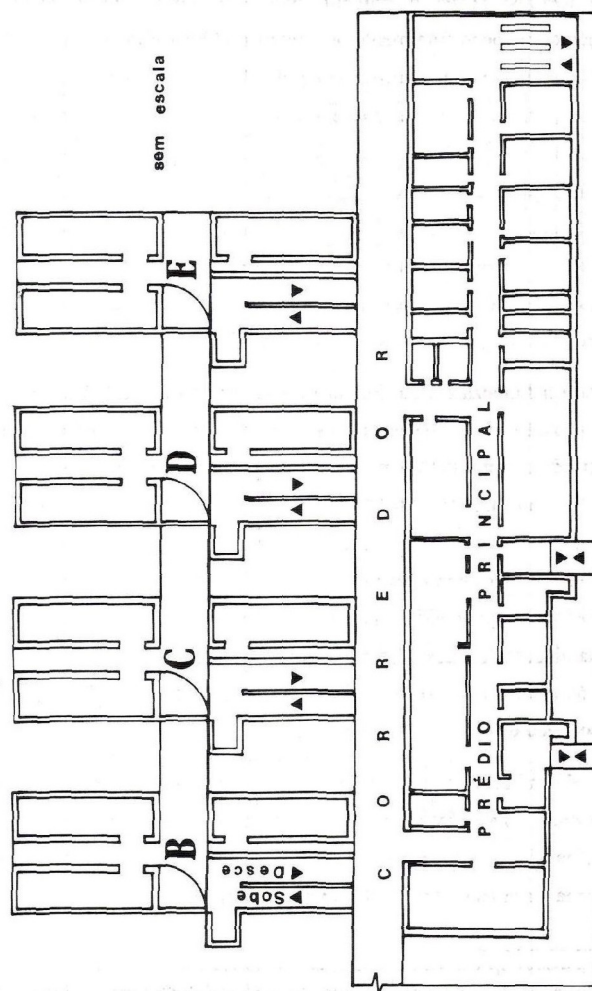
Planta Simplificada. Foto: Andrade, 1997.
